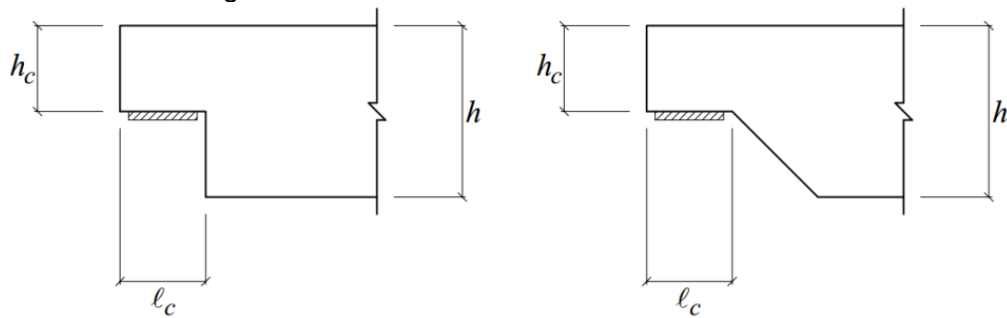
Ligações de estruturas pré-moldadas com dentes de concreto.
